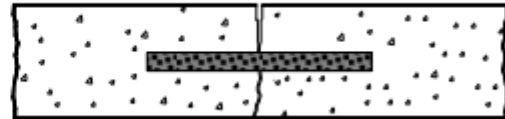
Junta transversal de contracción con pasadores. (Fuente: Instituto del Cemento Portland Argentino).
